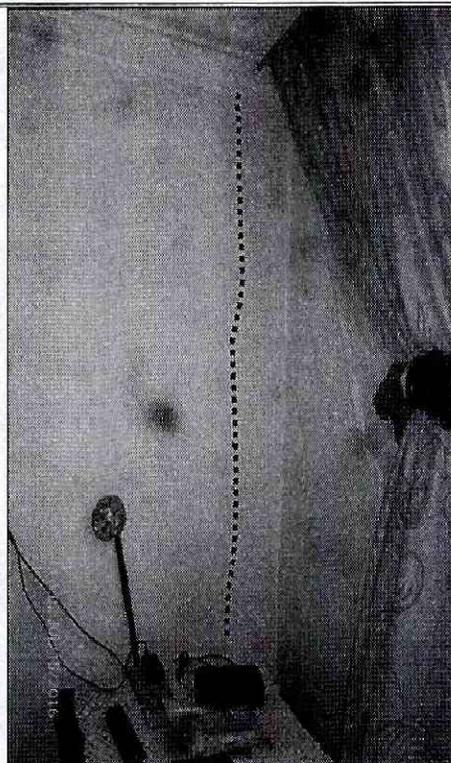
Fisuras identificadas en muros de cerramiento en la zona de escaleras de acceso a los apartamentos de las unidades habitacionales identificadas "Escalera 19" y "Escalera 26".
